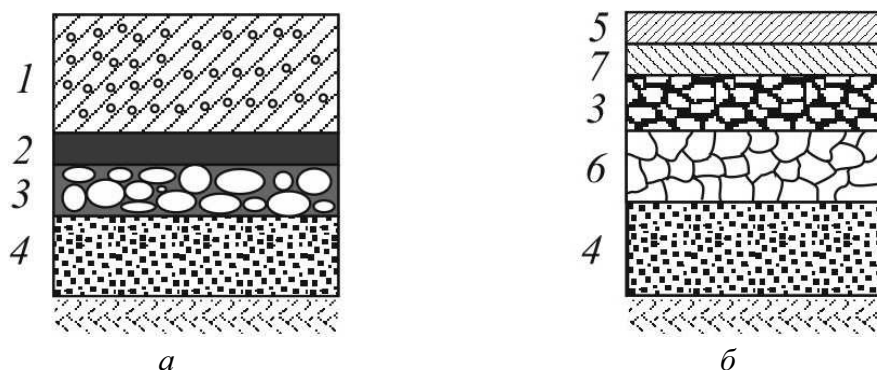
Типовые конструкции дорожных одежд: *а* – цементобетонное покрытие; *б* – асфальтобетонное покрытие на щебеночном основании; 1 – цементный бетон; 2 – выравнивающий слой из песка, обработанного битумом; 3 – слой щебня, гравия или грунта, обработанного вяжущим; 4 – морозозащитный слой из песка; 5 – мелкозернистый асфальтобетон; 6 – слой щебня; 7 – крупнозернистый асфальтобетон
